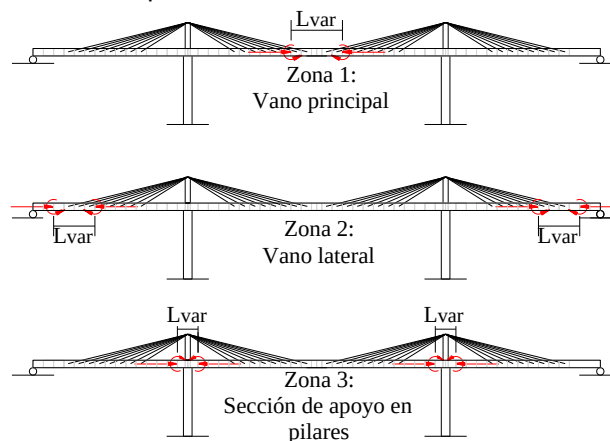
Uso de cables para la estabilización de los voladizos durante construcción.
